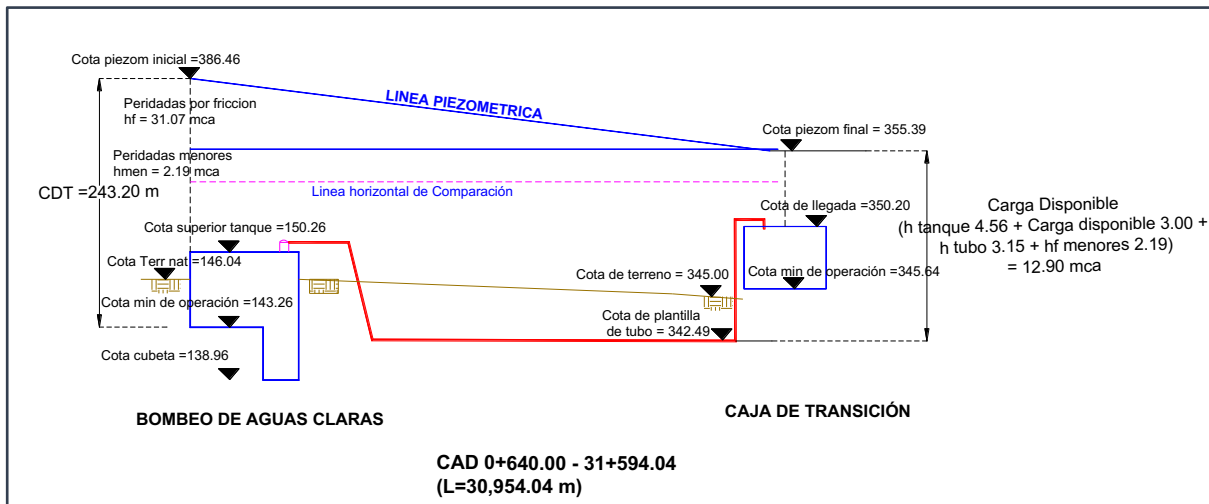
Piezométrica de la planta potabilizadora caja de transición El Melón, Alternativa 3
